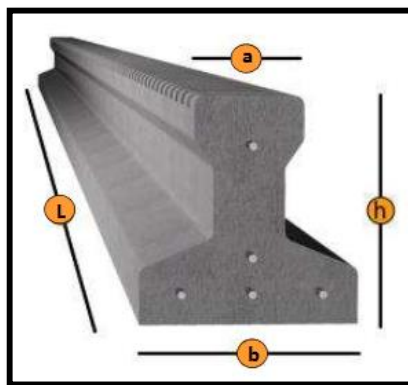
Losa Alivianada con viguetas pretensadas
